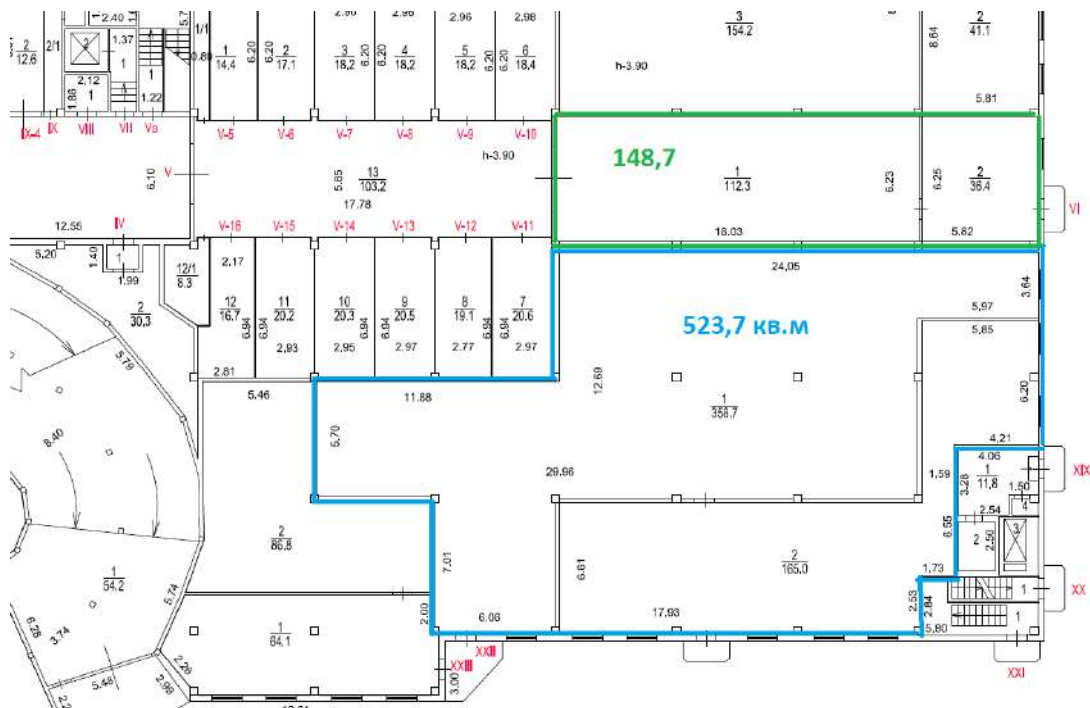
Схема оцениваемых помещений на плане этажа №1
